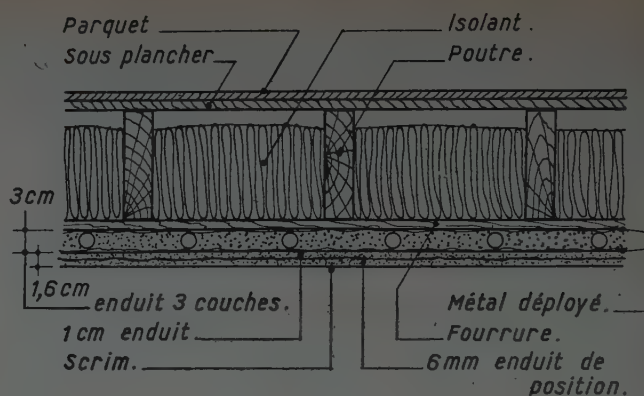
Coupe montrant la méthode anglaise de construction des panneaux de plafond enrobés dans l'enduit entre deux couches de métal déployé.
